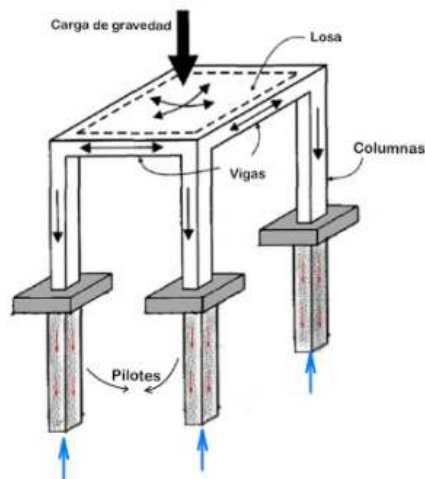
Distribución de cargas verticales de un pórtico a la cimentación.
